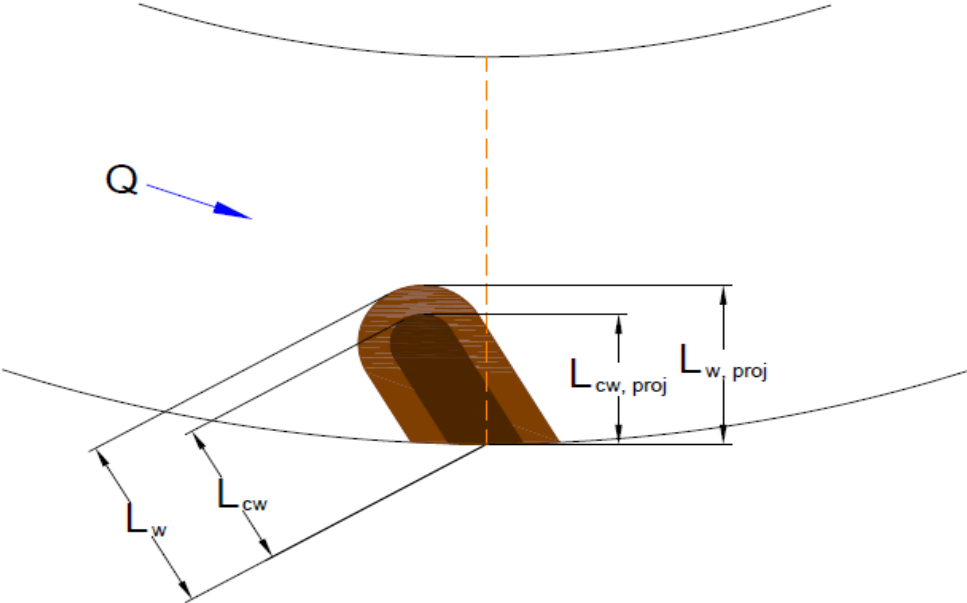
Vista en planta de la longitud proyectada del espigón
